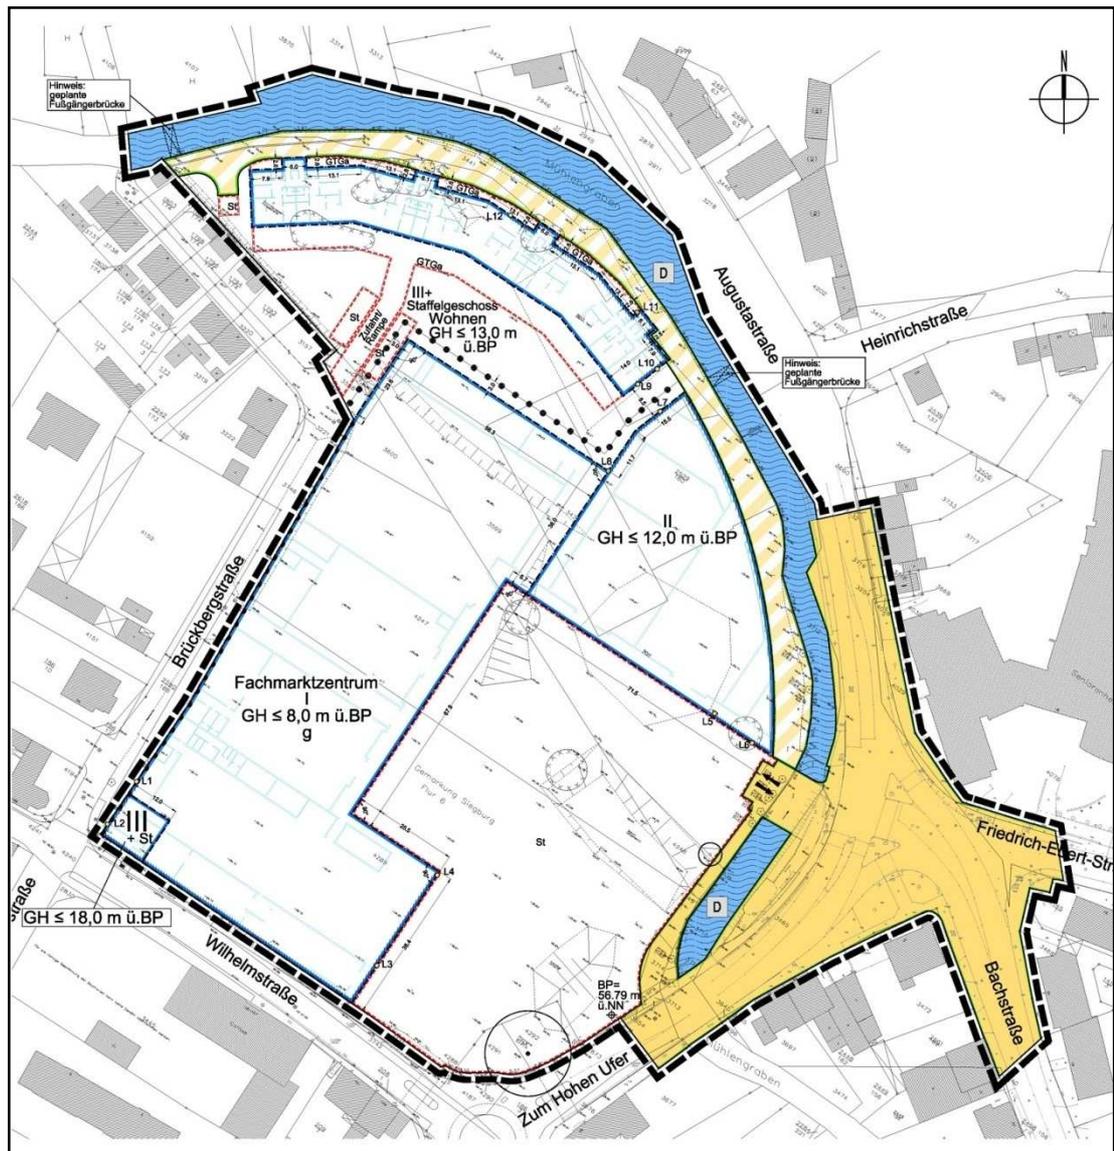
Lageplan der geplanten Bebauung auf dem „ehemaligen Lüghausen-Gelände“
